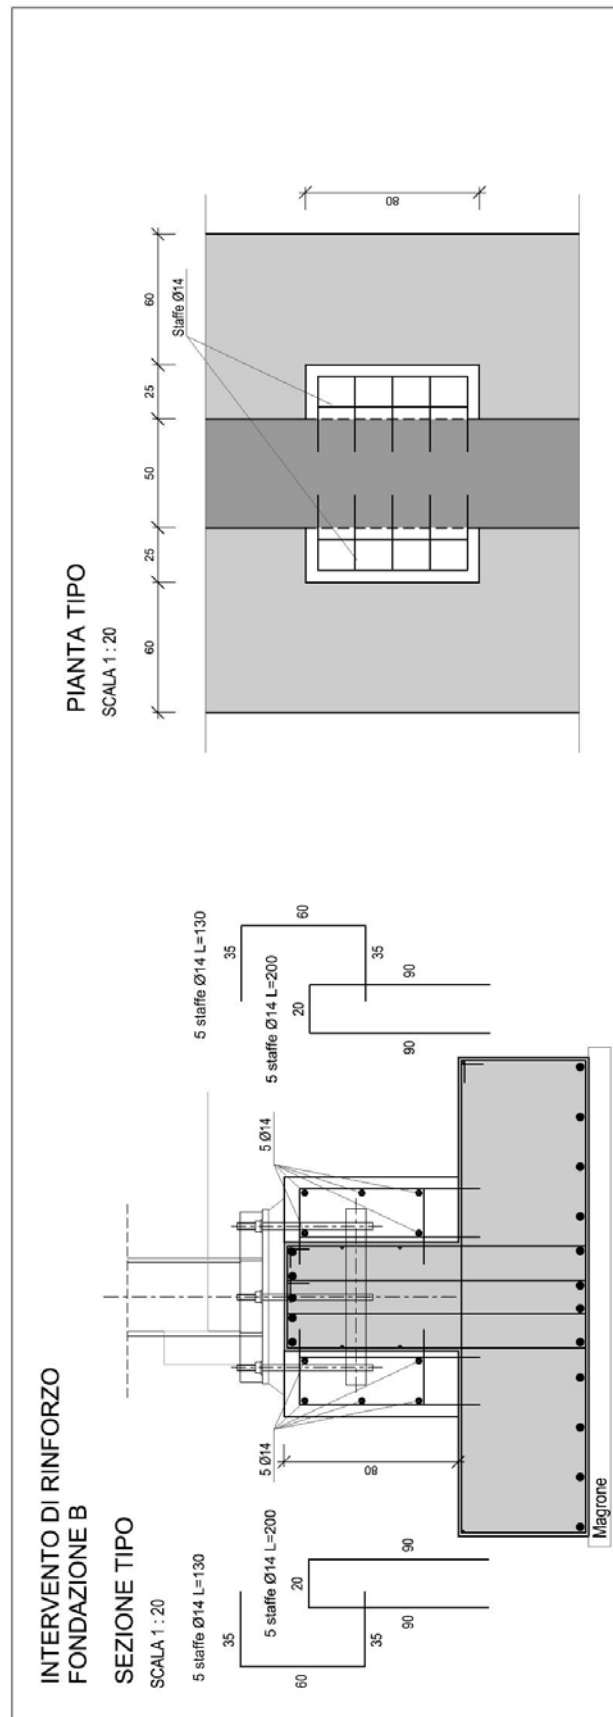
Particolare di A.2006.a.us.T02 - Pianta e particolari fondazioni - Particolari trave tipo B
